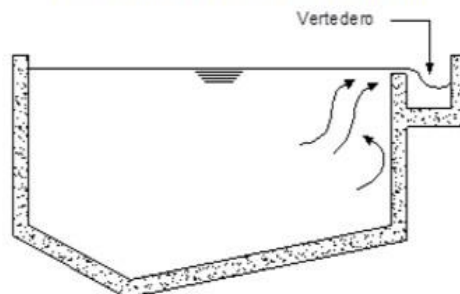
Esquema de la tolva de arenas – planta
